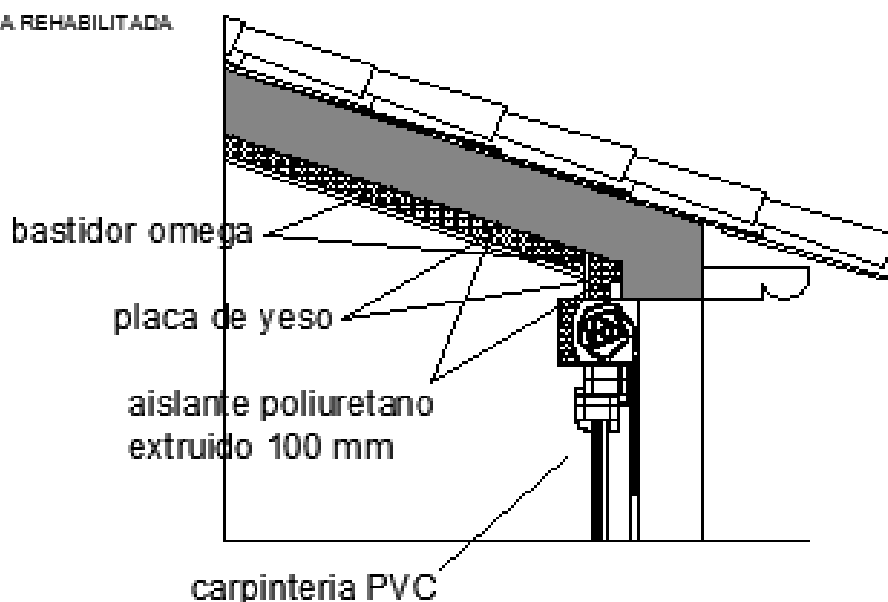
Detalle de aislamiento térmico por el interior de cubierta
